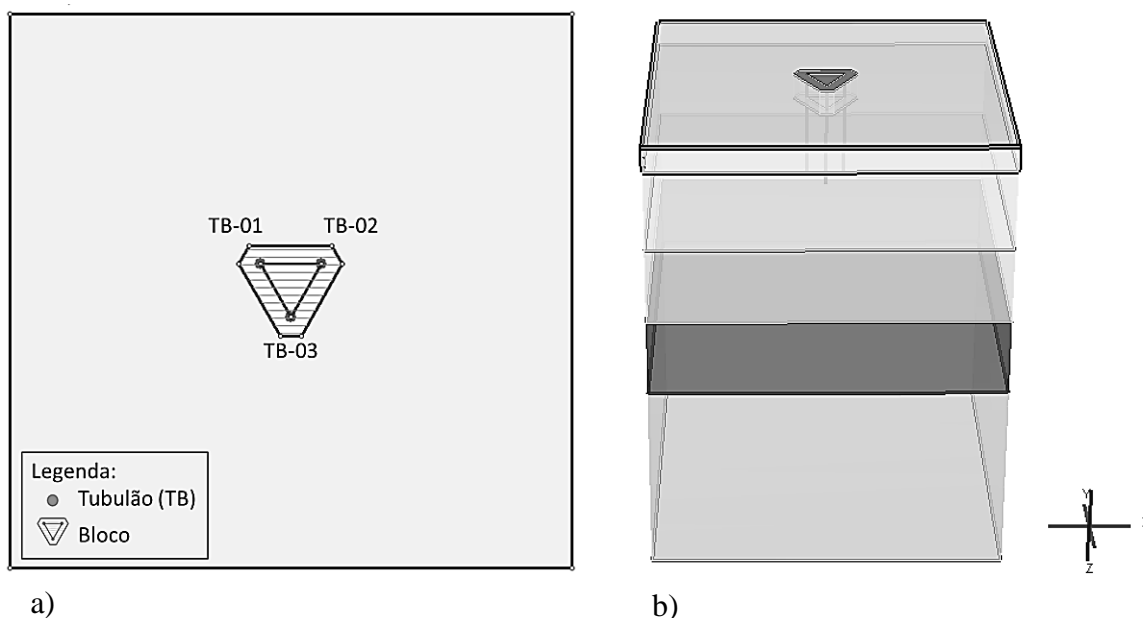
Tubulões e bloco. a) Planta; b) Perspectiva.
